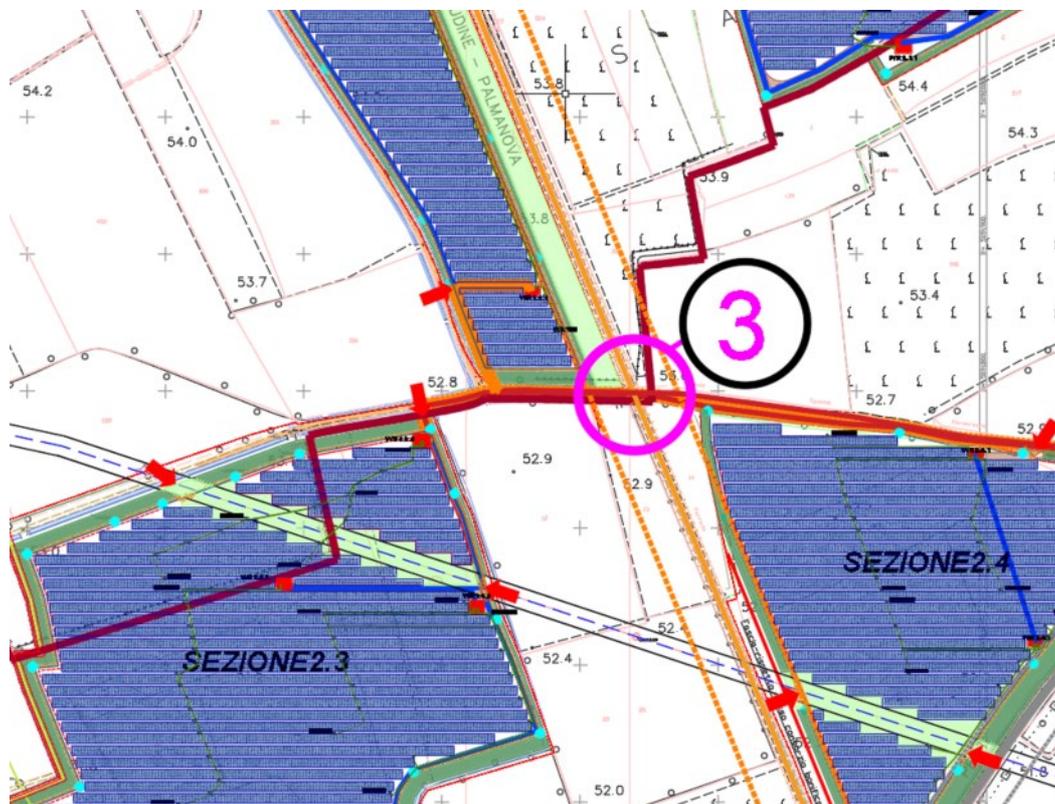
Planimetria ipotesi attraversamento linea ferroviaria
